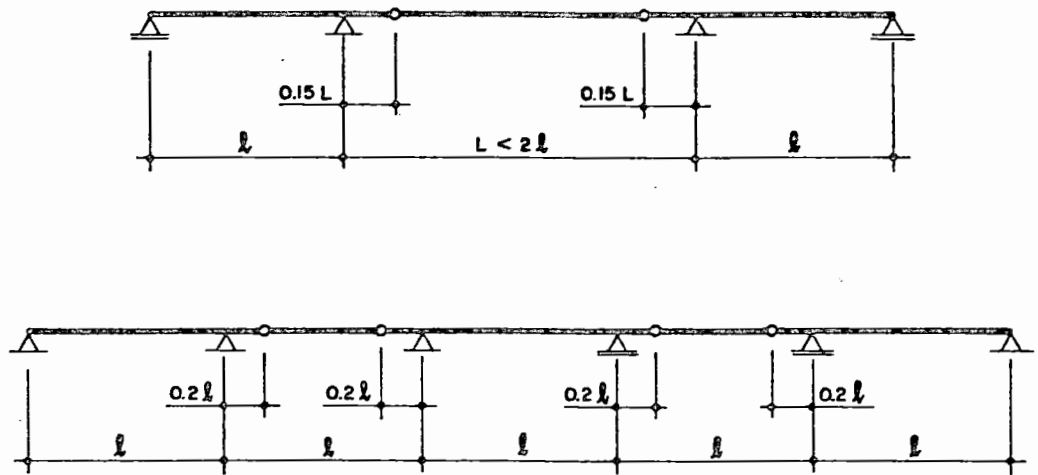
POSIÇÃO DAS ARTICULAÇÕES NAS PONTES DE VIGAS GERBER [MARTINELLI(1971)]
